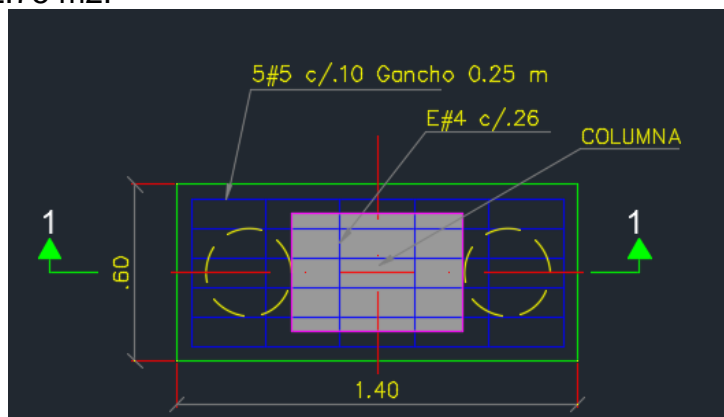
Ilustración de refuerzo planta cabezal tipo 1 (CB-1)
